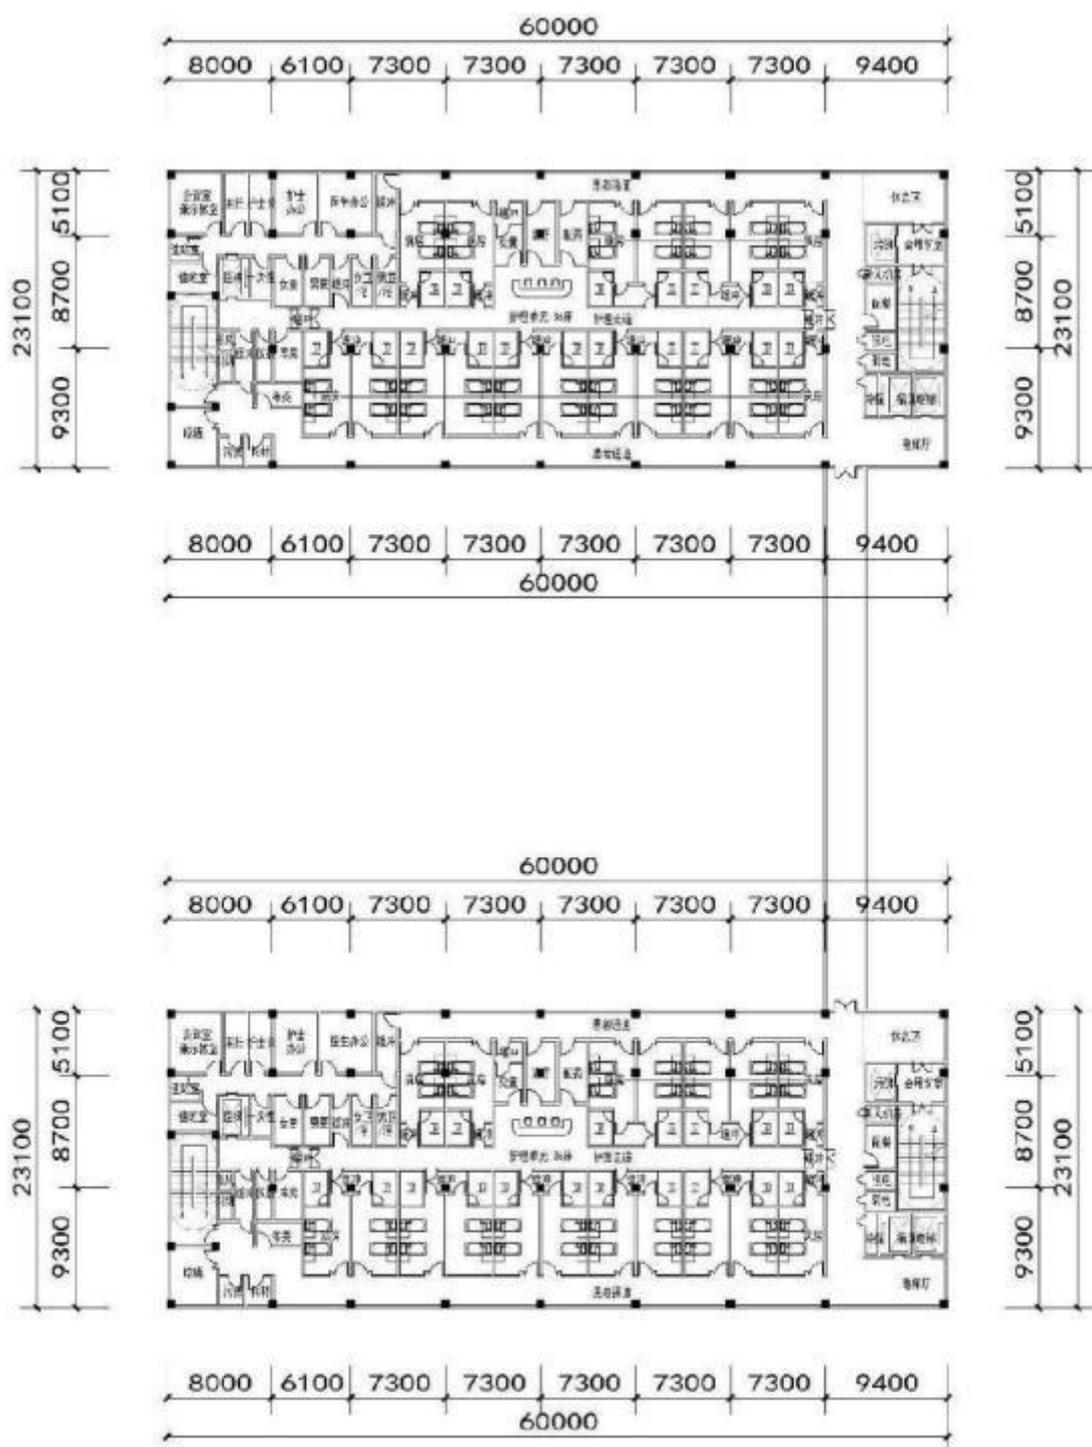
(3) 各层平面布置图 (南院区门诊医技楼)
